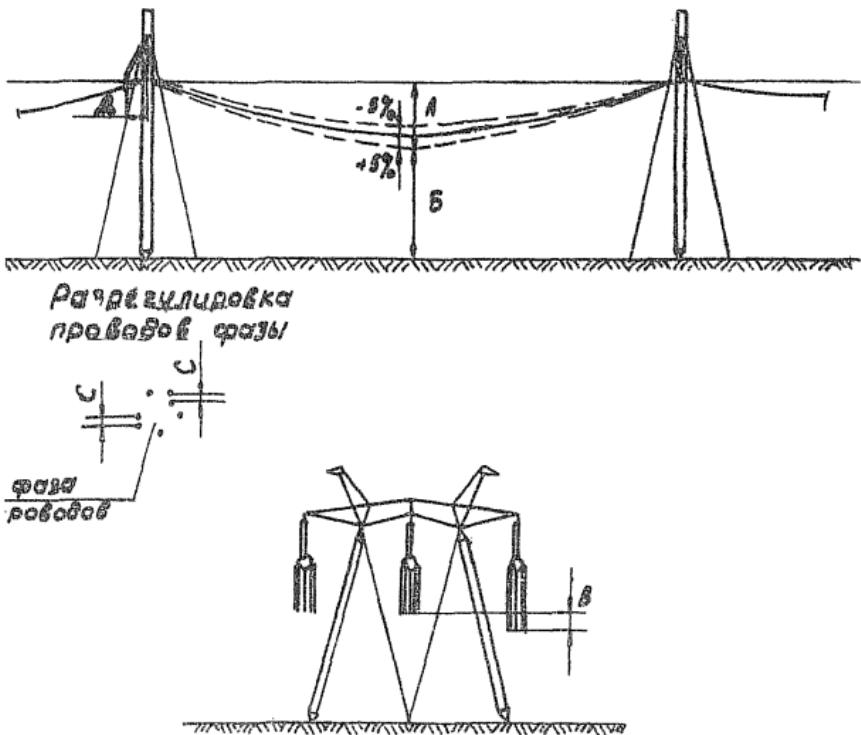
Допуски на монтаже проводов (СНиП II-33-76 п.10.66).
